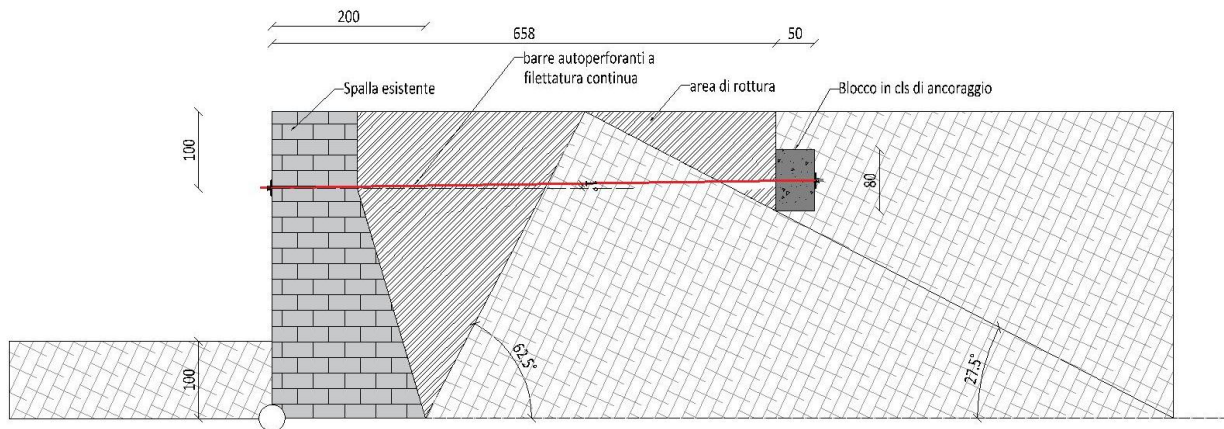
Sezione per intervento di rinforzo delle spalle
